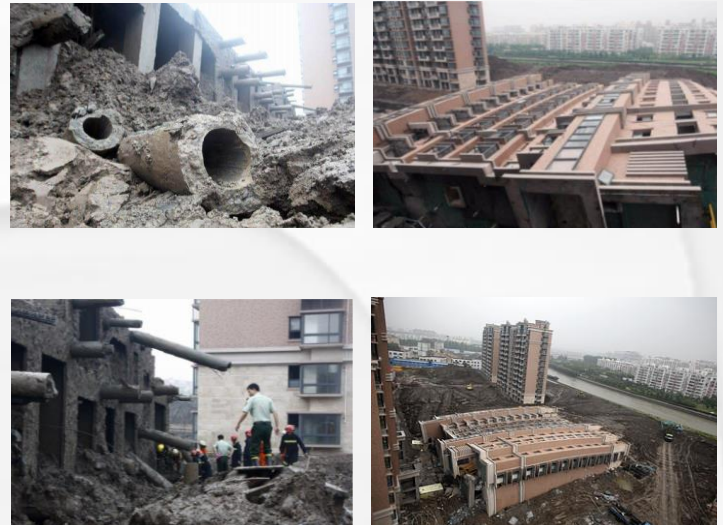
Pilas de concreto del Lotus Riverside Block 7 fracturadas debido a la sobrecarga. Fuentes: <https://failures.wikispaces.com>, <http://blog.pucp.edu.pe>, <http://online.wsj.com>
